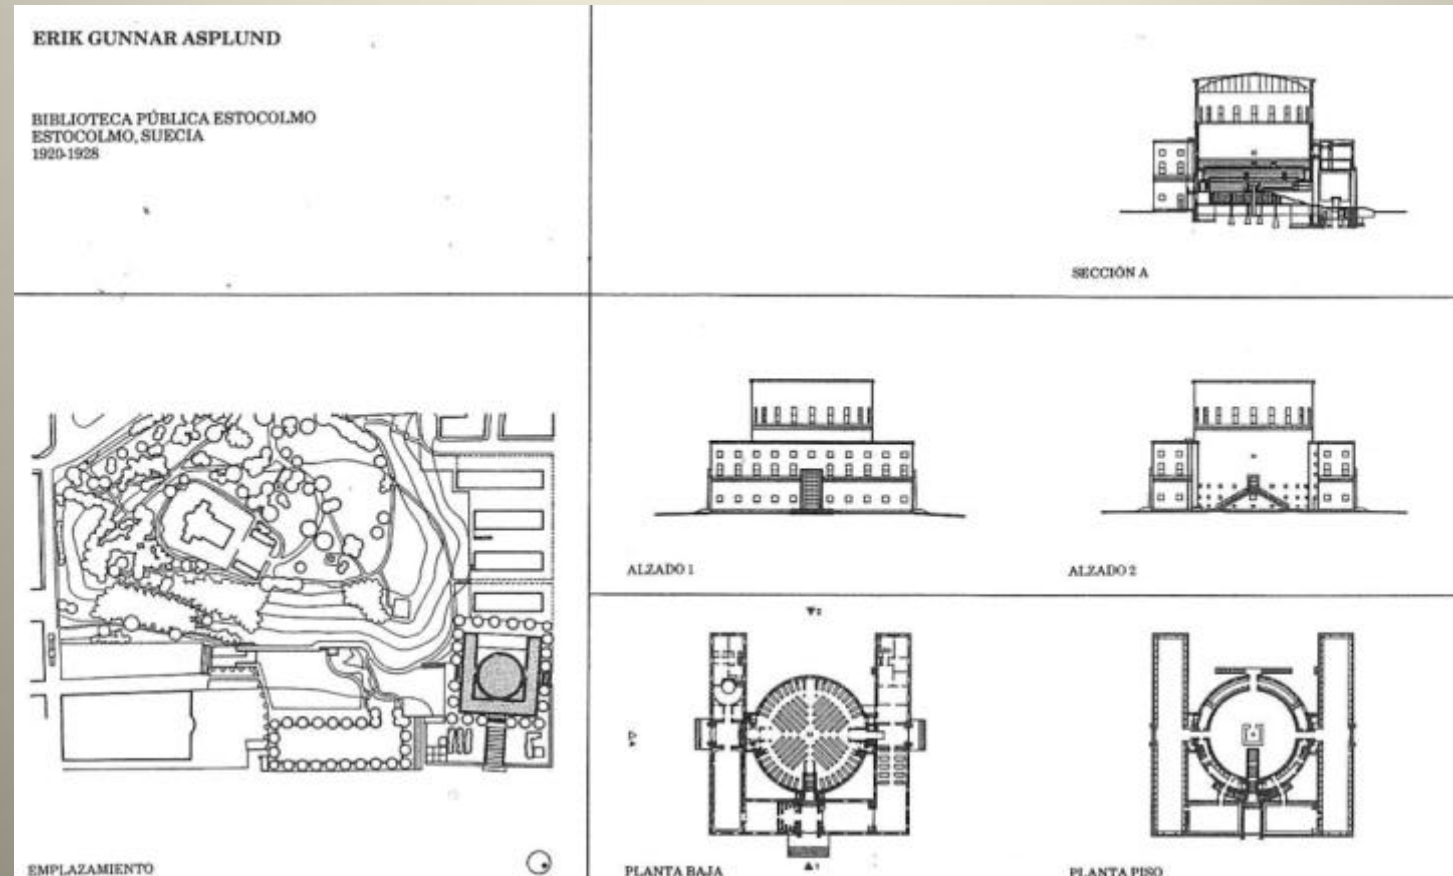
Implantação, Planta, Corte e Elevação - Biblioteca Pública de Estocolmo (pág. 26)
